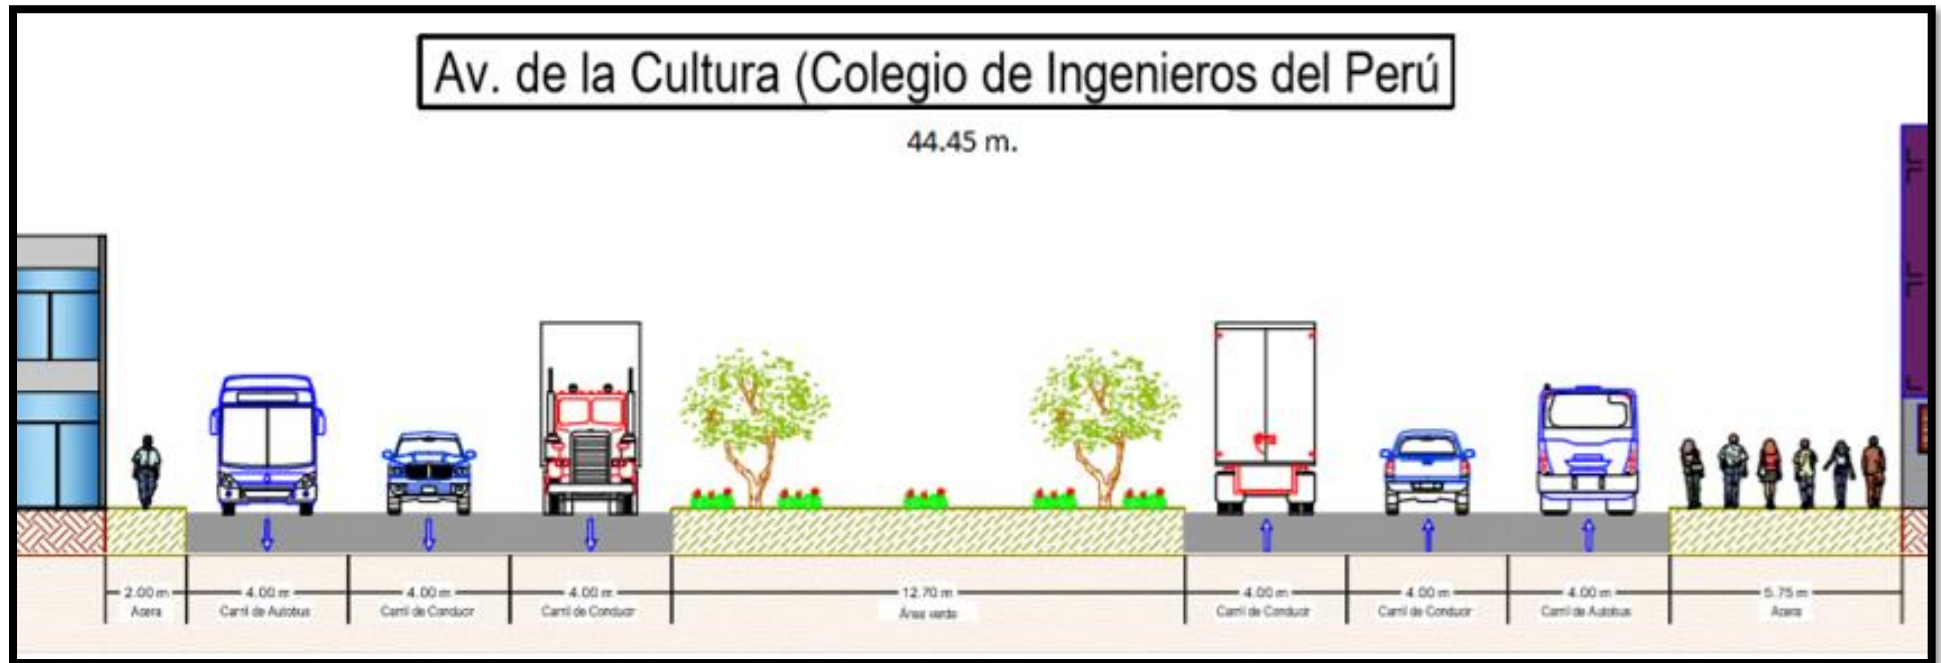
Modelamiento en AutoCAD de las secciones transversales
